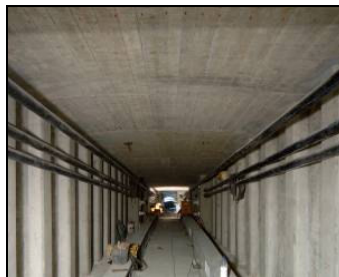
Colocação de pré-esforço exterior (Ponte da Barra, EP2007).
